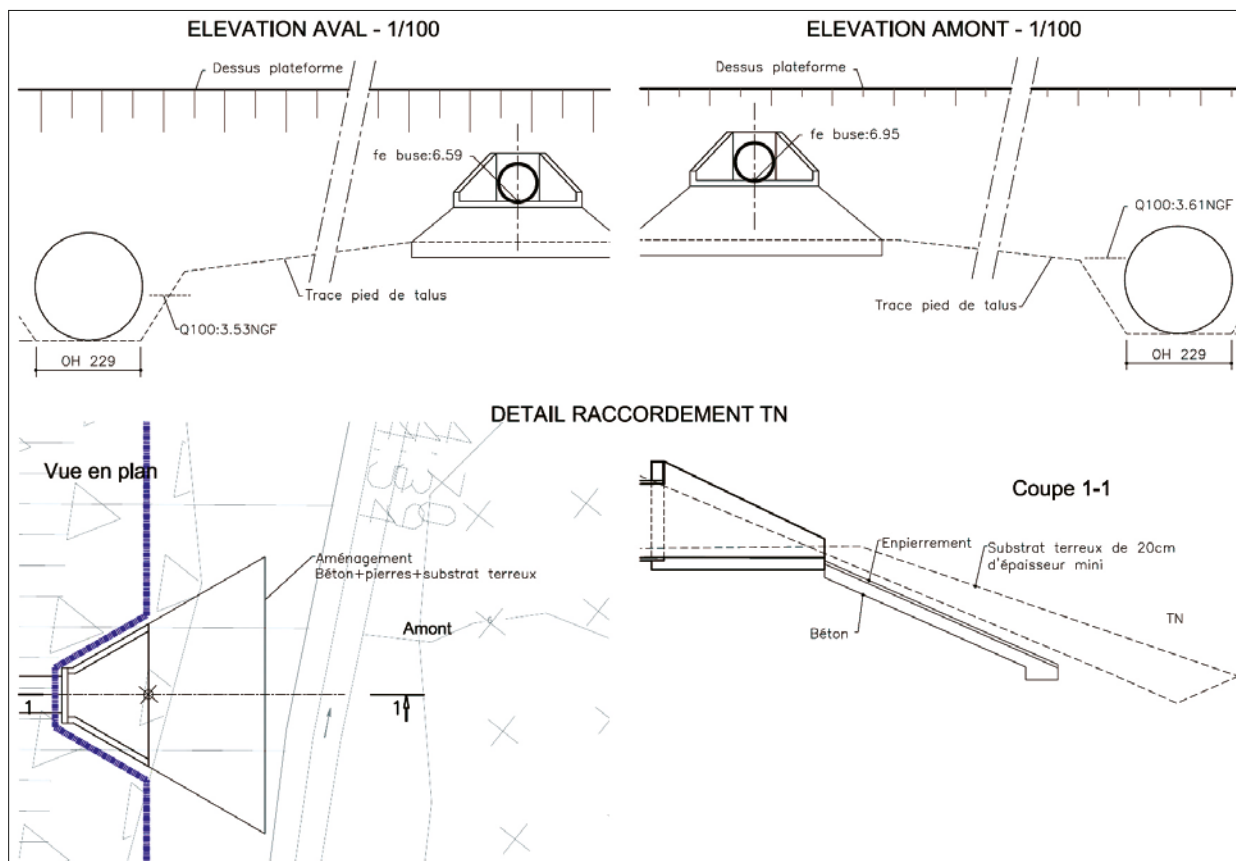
Plan AVP d'un écoduc faisant apparaître le Q100 et les élévations.
